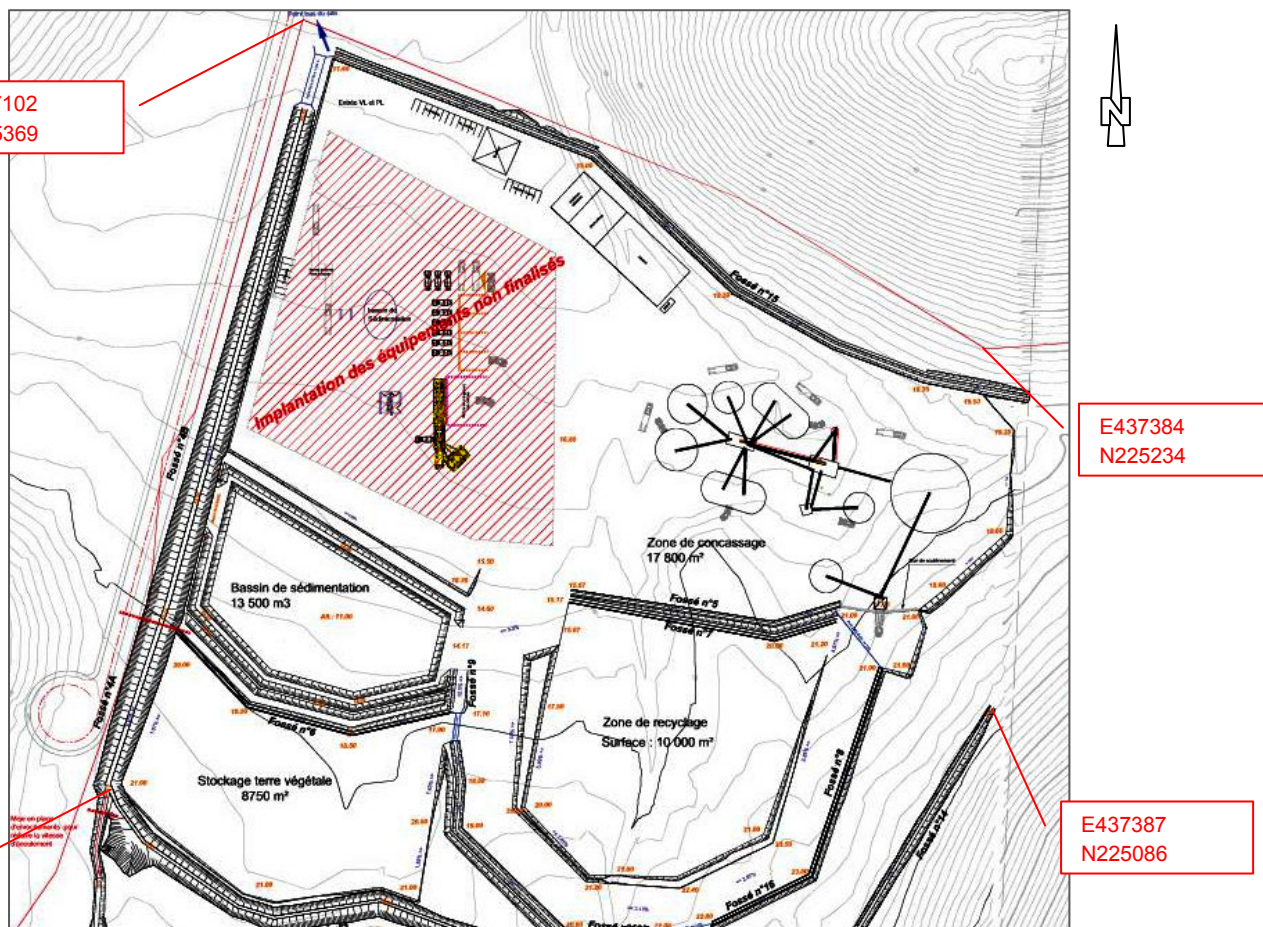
Extrait Plan VRD01 plan de terrassement – zone des installations (Données GINGER SOPRONER)
